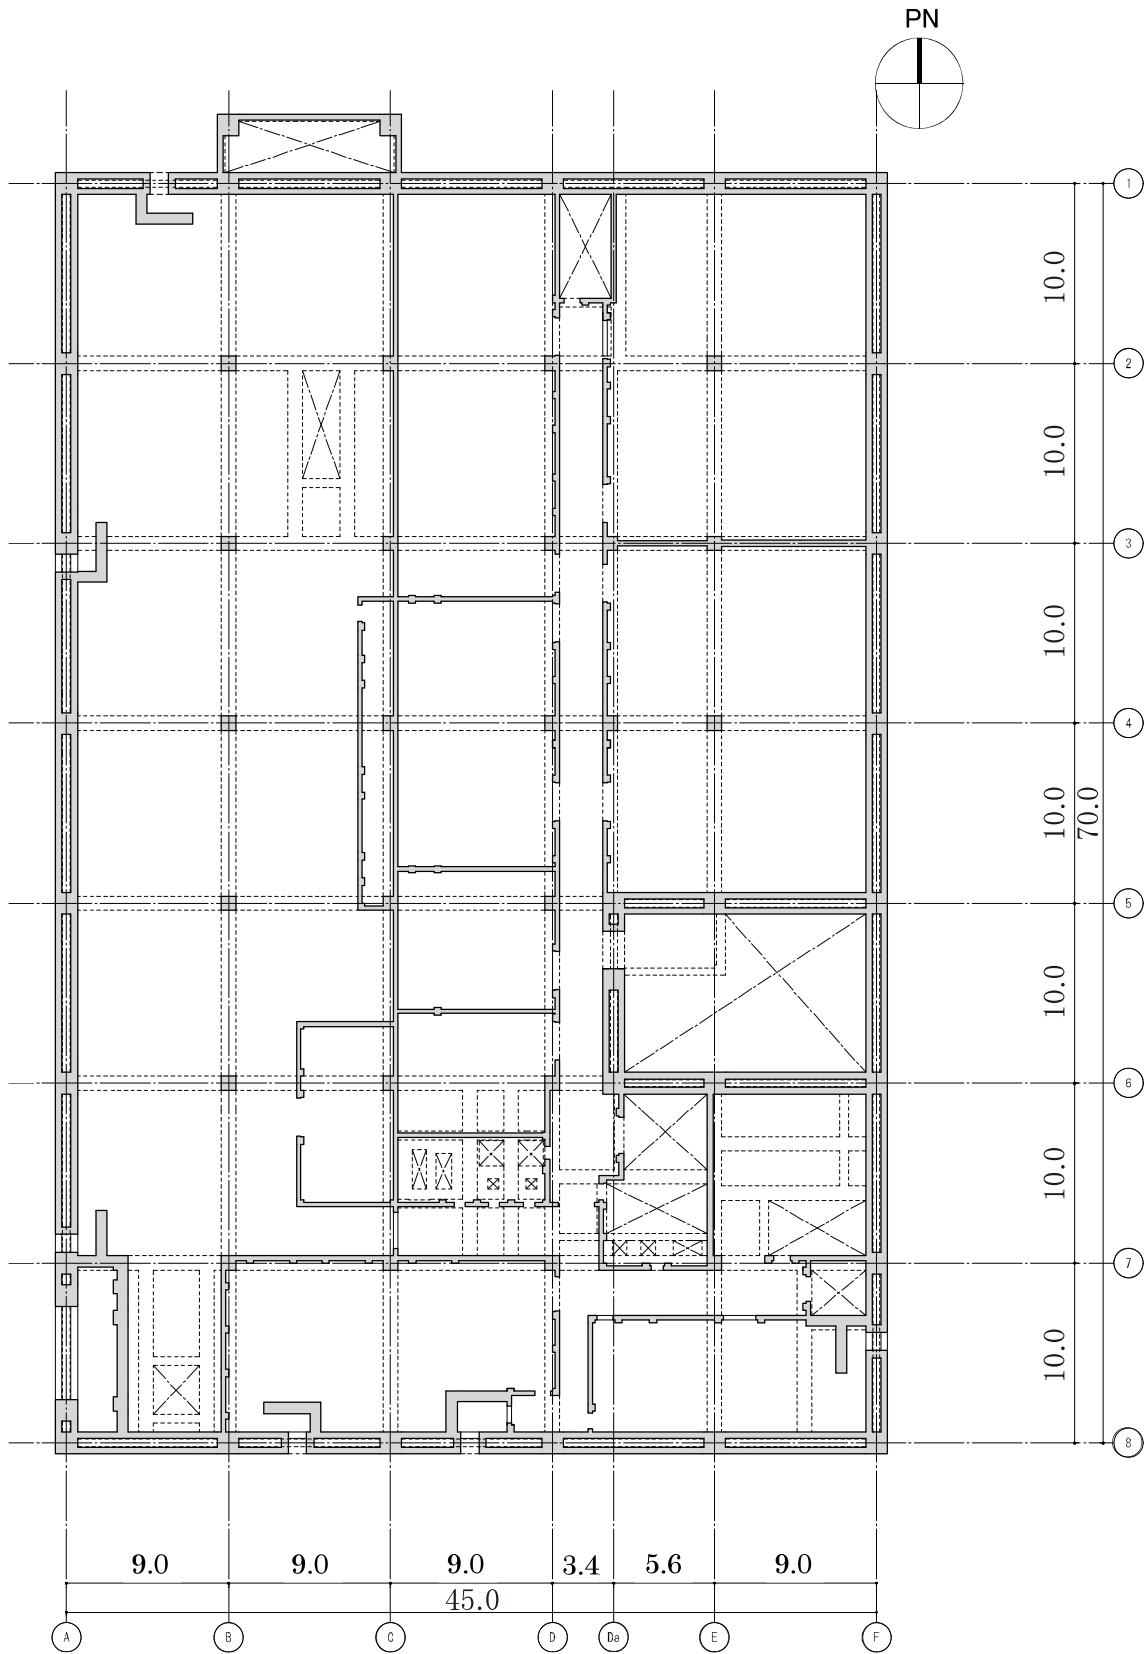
3 階平面図 (G. L. +15.80) (单位 : m)
